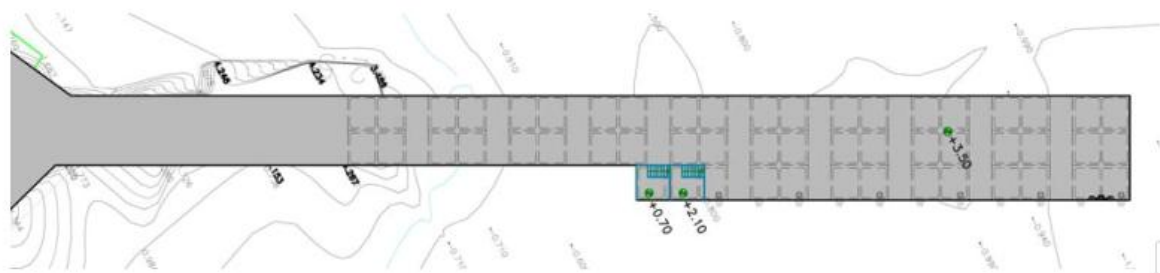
Proposta de layout do cais de Porto Alegre– Fonte: Projeto fornecido pelo cliente
